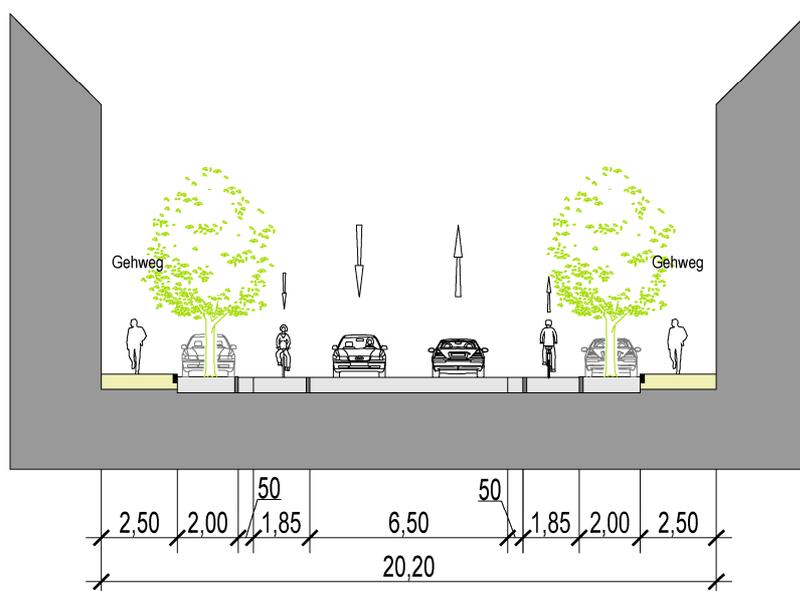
Baulich geschützter Radfahrstreifen mit 2,30 m Führungsbreite (Zielwert laut Grundsatzbeschluss) mit beidseitigem Kfz-Parken [Quelle: BSV]
